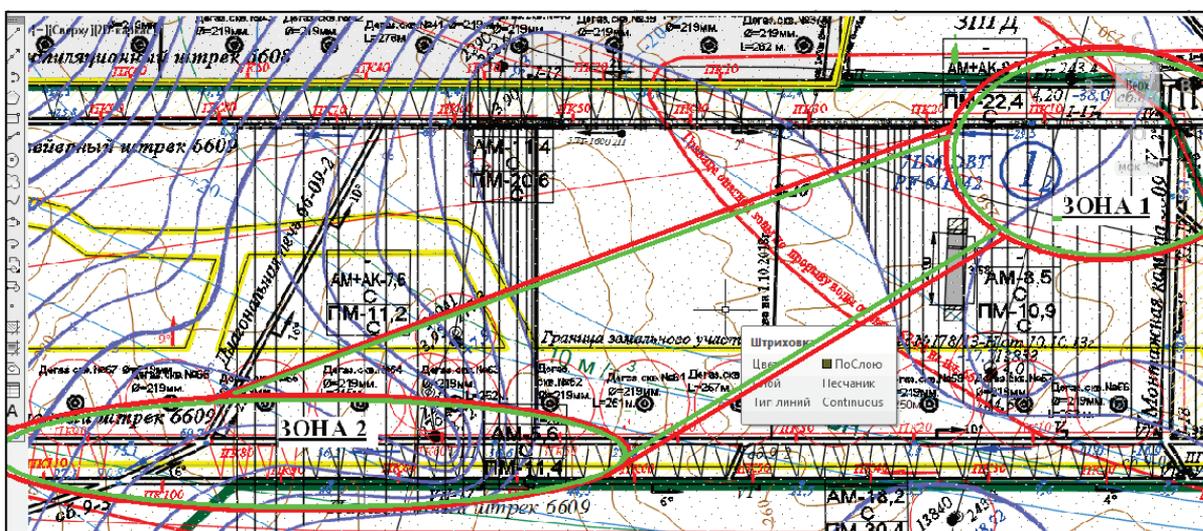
Выкопировка с плана горных работ с зонами аномалии № 1 и № 2
